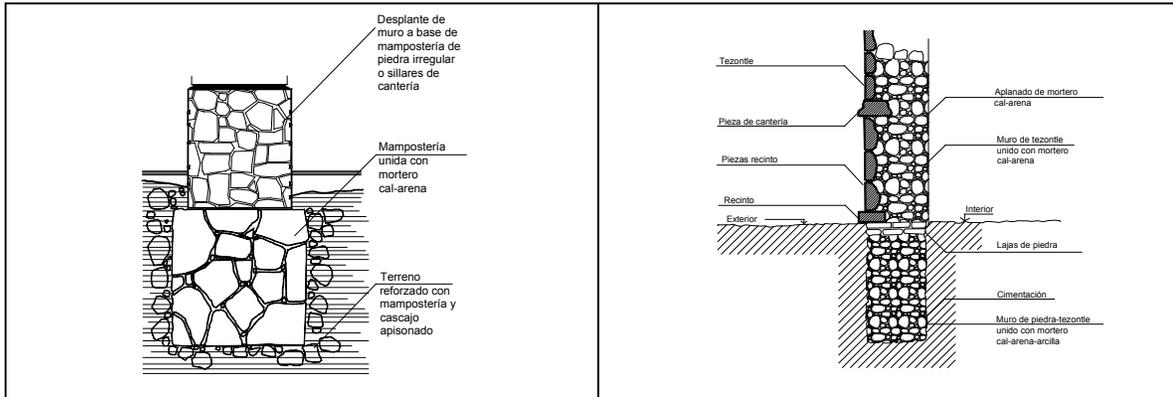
Cimentación y desplante de muros de mampostería, Siglo XVIII.
